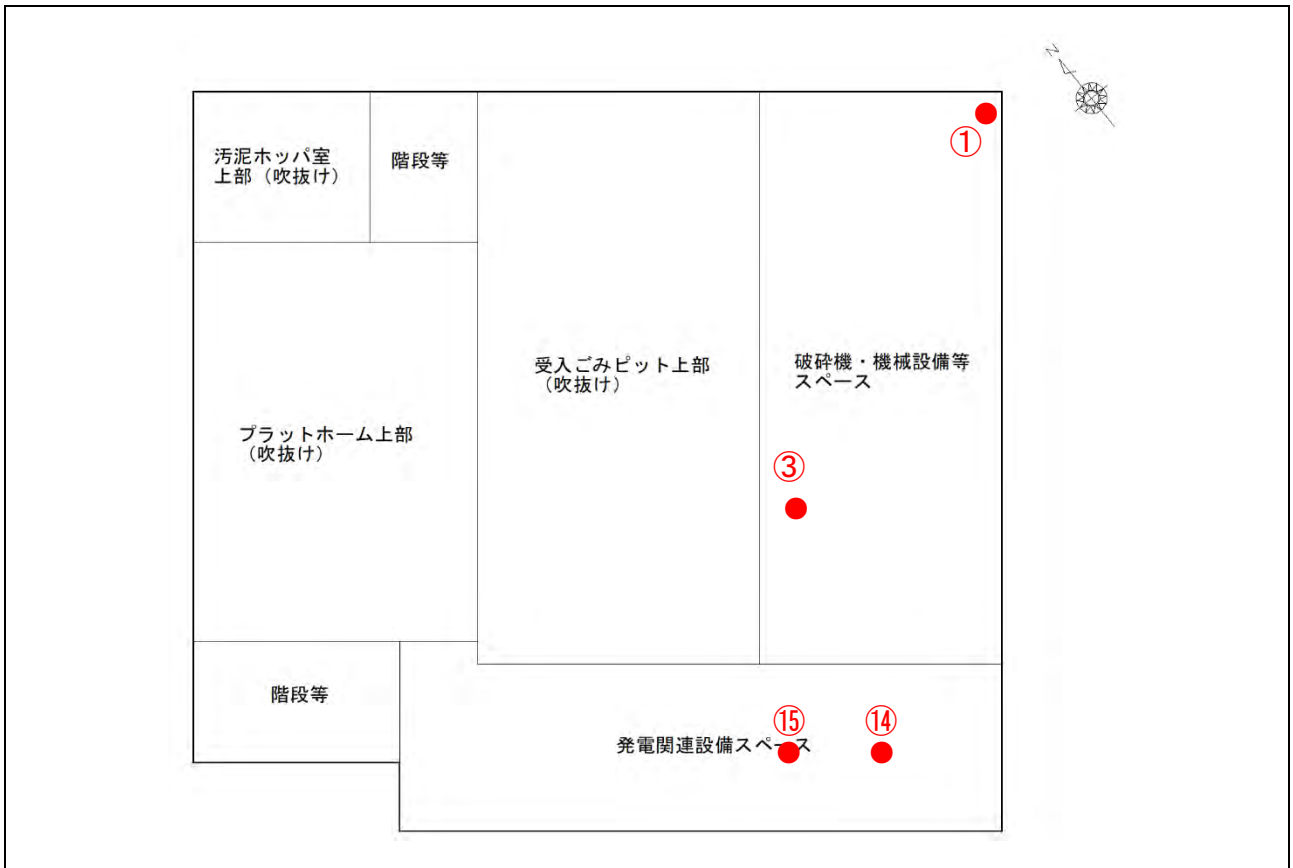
(3) 廃棄物受入棟平面図 (2 階)
